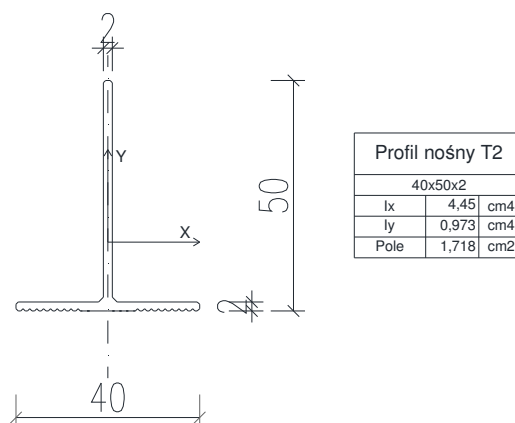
Profil podkonstrukcji aluminiowej typu T przystosowany do wkładów z taśmy nierdzewnej
